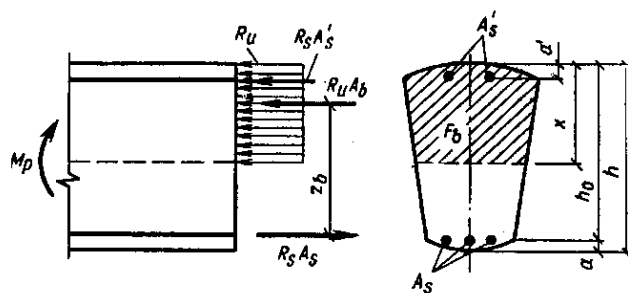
К расчету ЖБК методом разрушающих нагрузок
